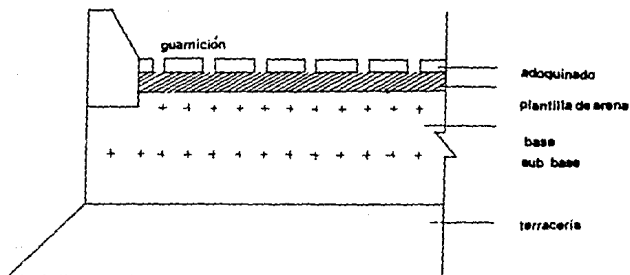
Sección típica de un pavimento de adoquín para tránsito
